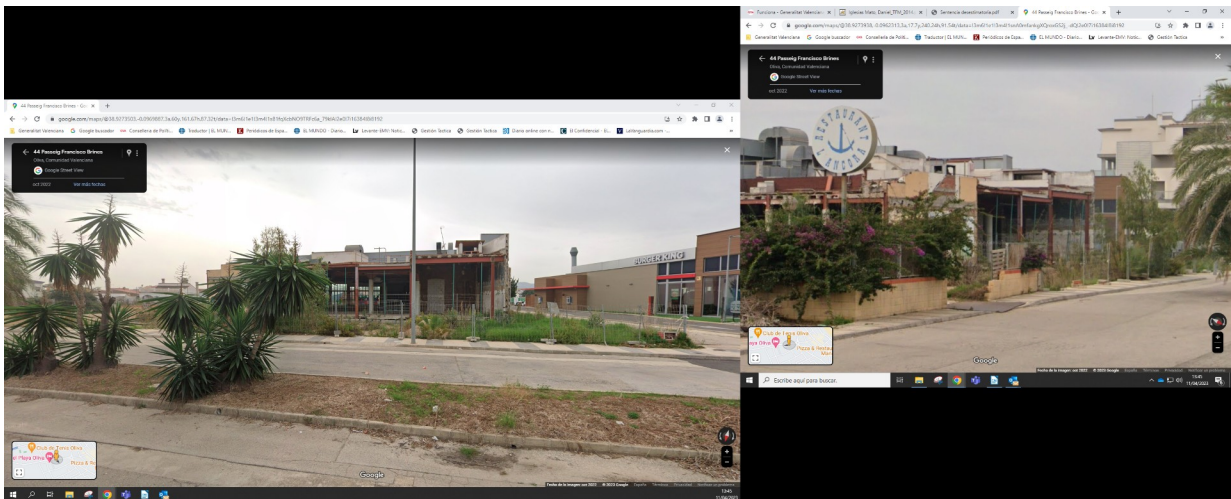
Obsérvense las obras de demolición de la fachada construida en su día y el retranqueo del nuevo cerramiento para adecuarse a parámetros del planeamiento urbanístico de Oliva.
